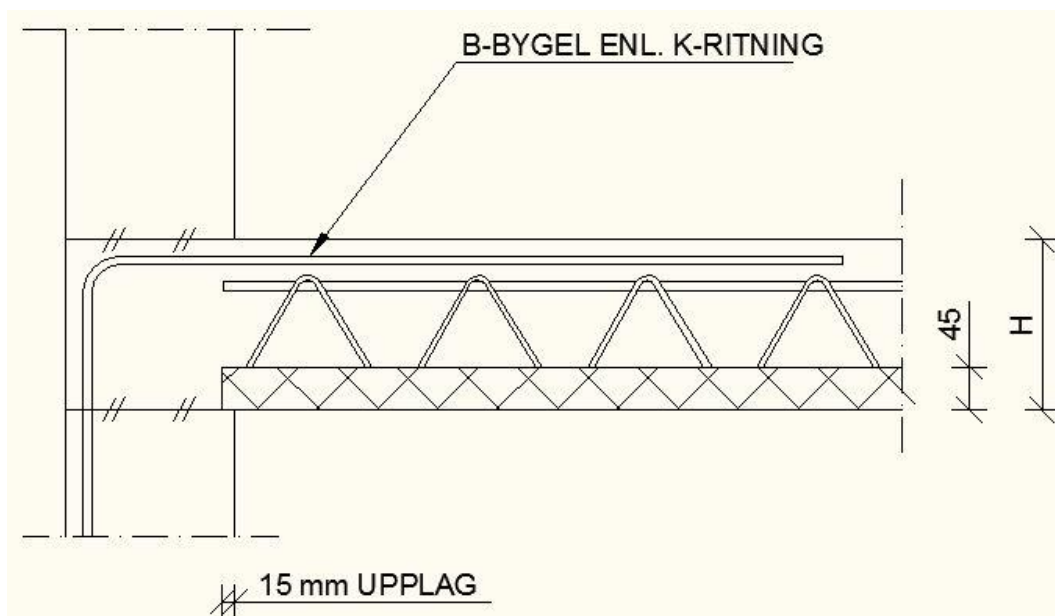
Sektion plattbärlag Källa: Betongbanken 2011, *Konstruktionsdetaljer
